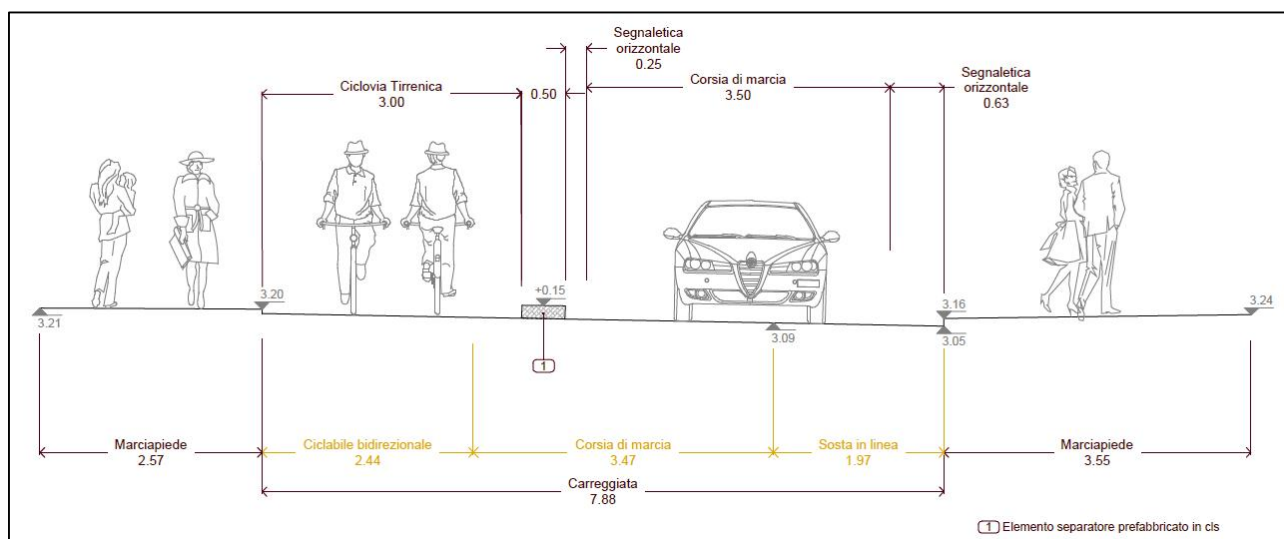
Sezione 04 di progetto trasversale su Viale Italia
